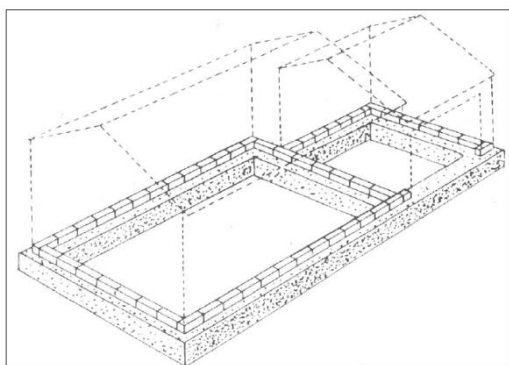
Fondations sur semelles filantes (d'après Ernst Reuter)
